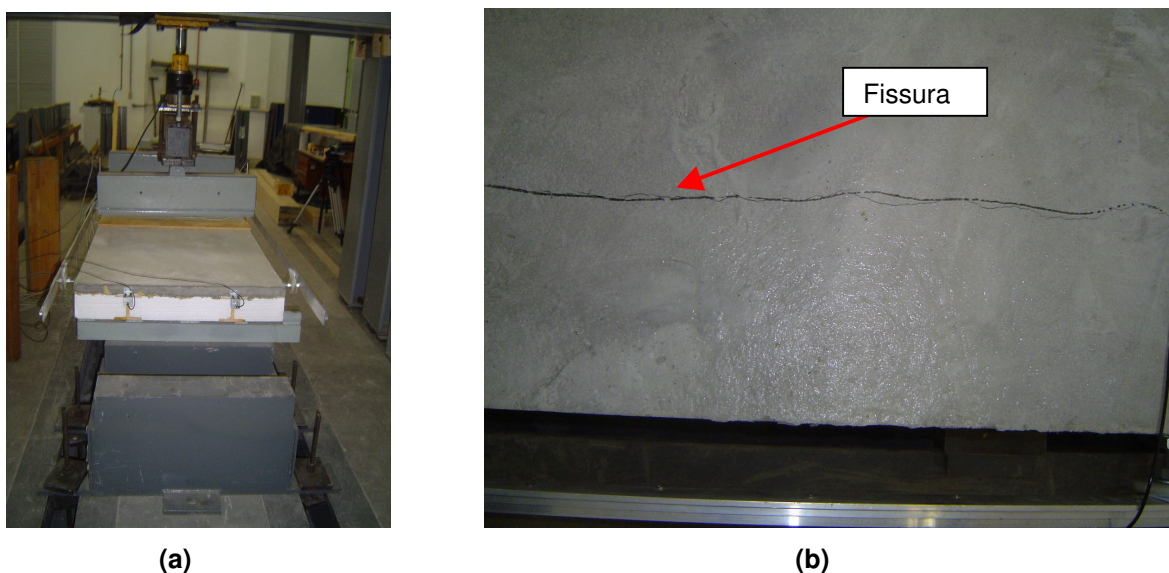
(a) vista da laje no ensaio; (b) fissura formada sob um perfil de PRFV.
